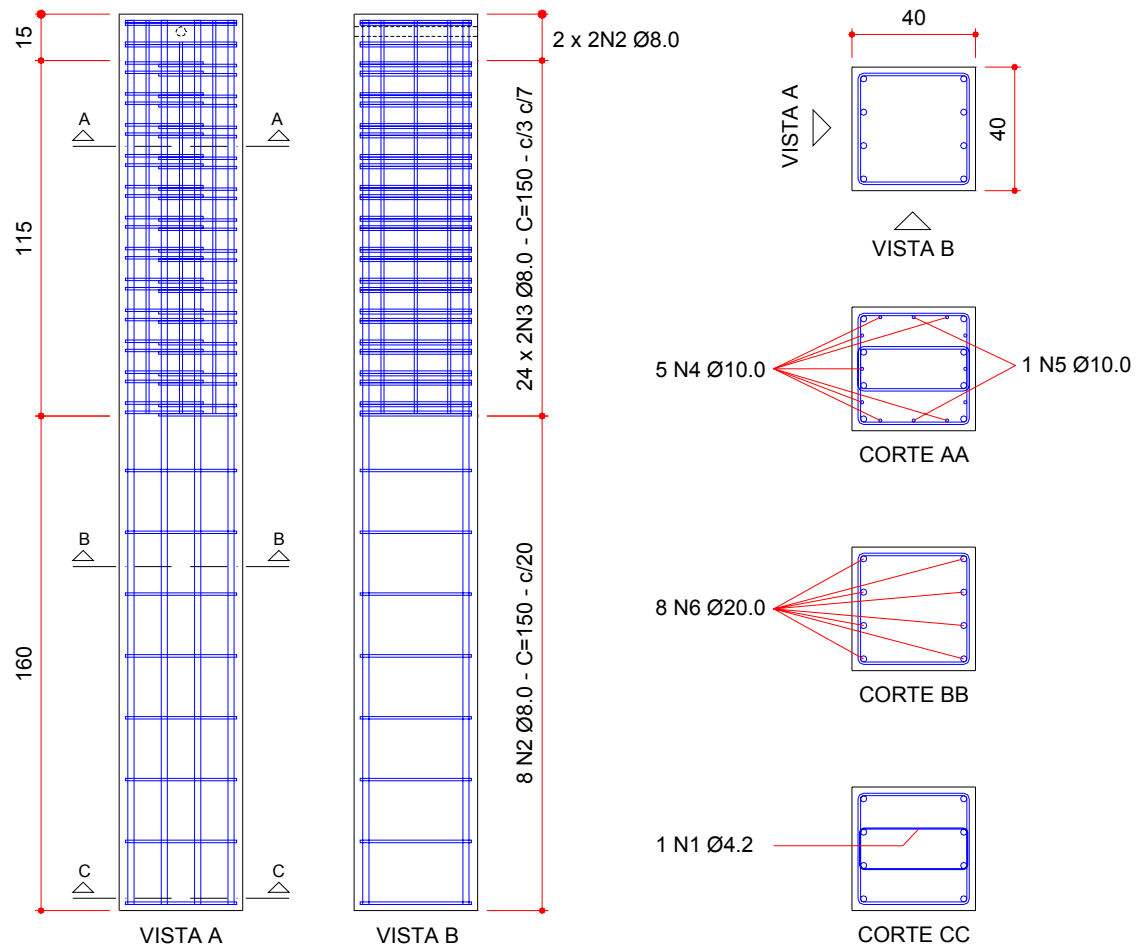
Geometria e distribuição da armadura dos Pilares
